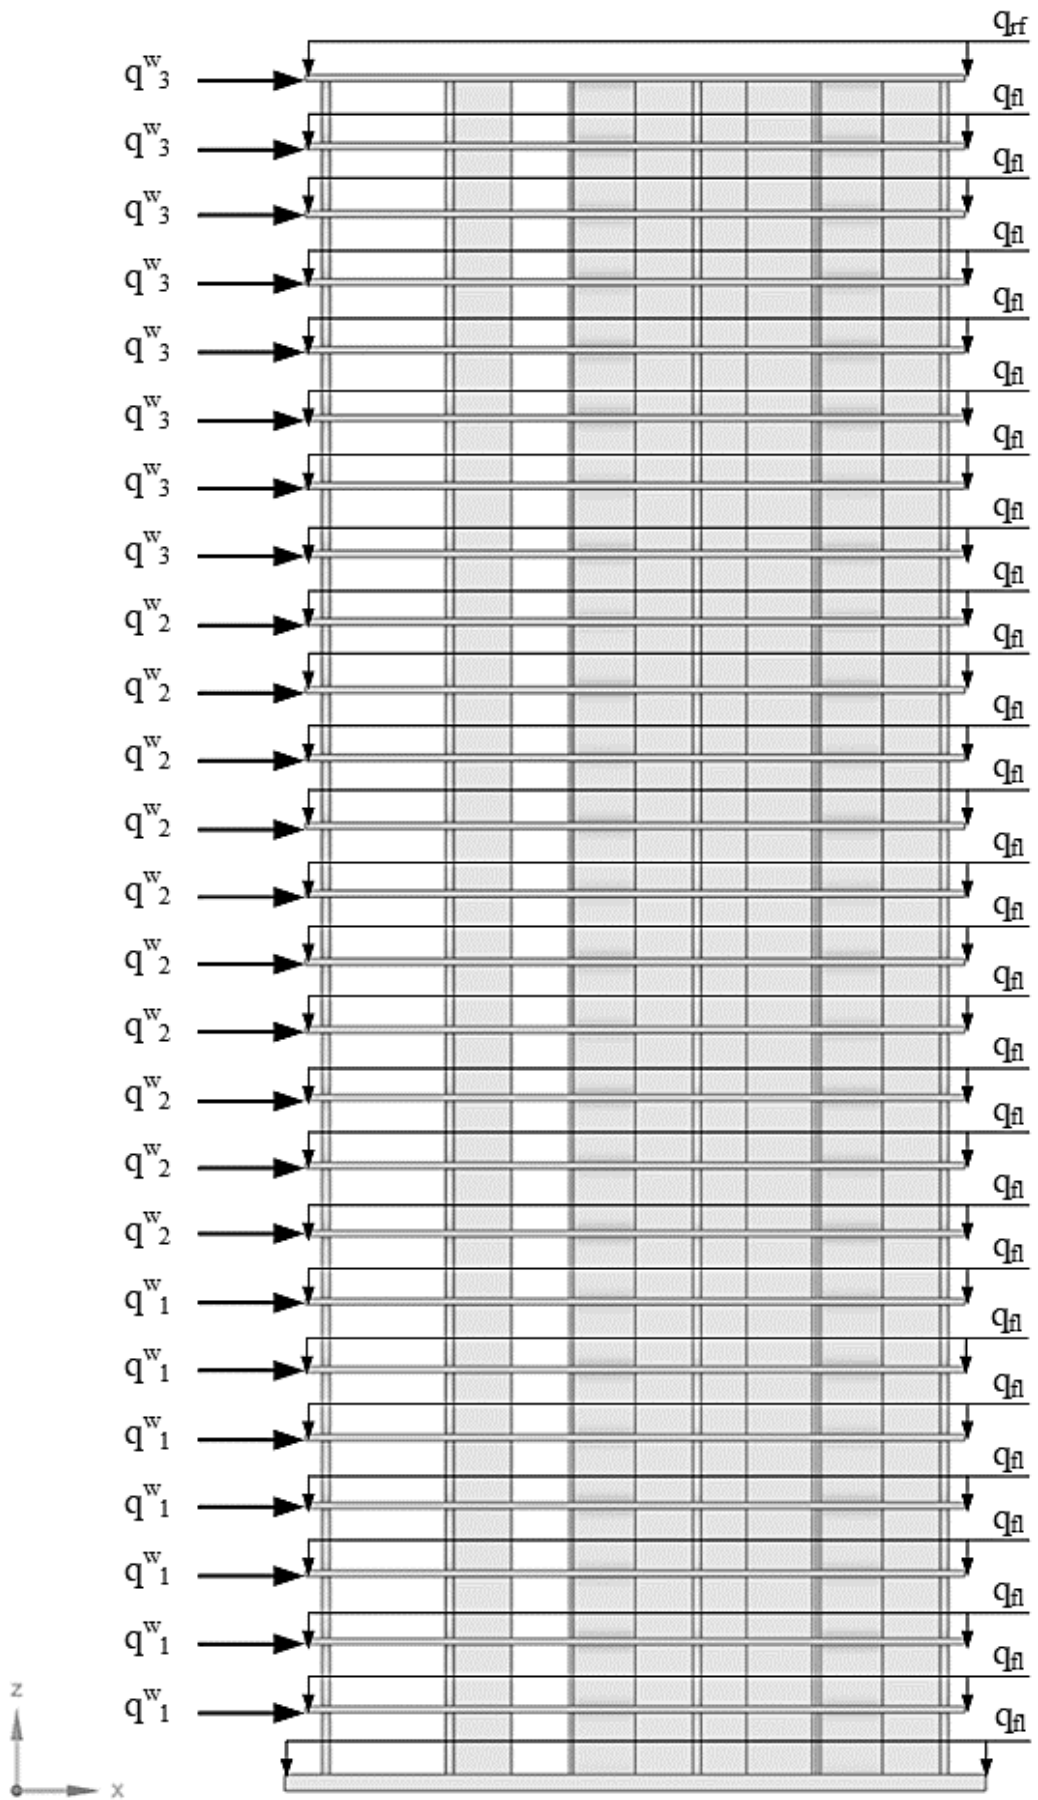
Южный фасад расчётной схемы (см. таблицу 4.6)
